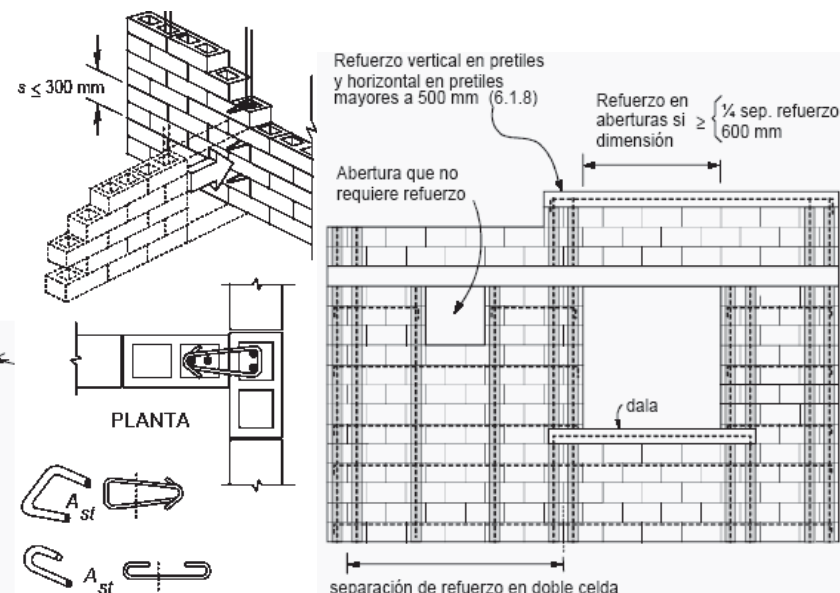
REFUERZO EN ABERTURAS Y PRETILES
